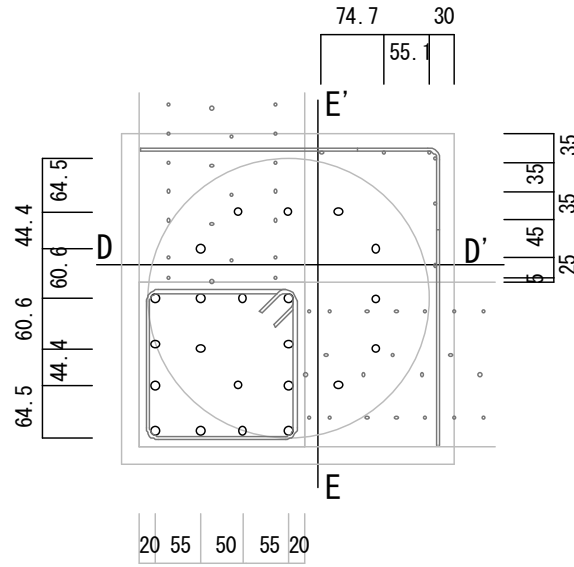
E39 試験体配筋状況 (柱切断面)
